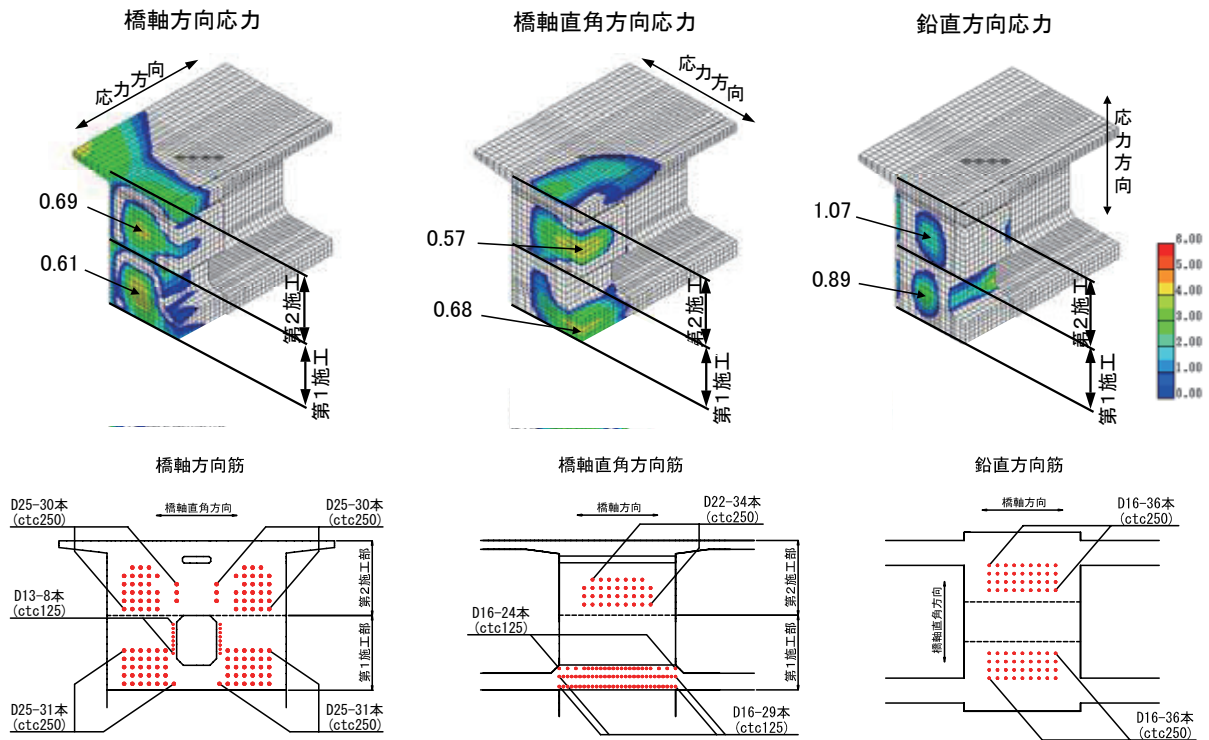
ひび割れ指数コンター図およびひび割れ抑制鉄筋配置概要図
